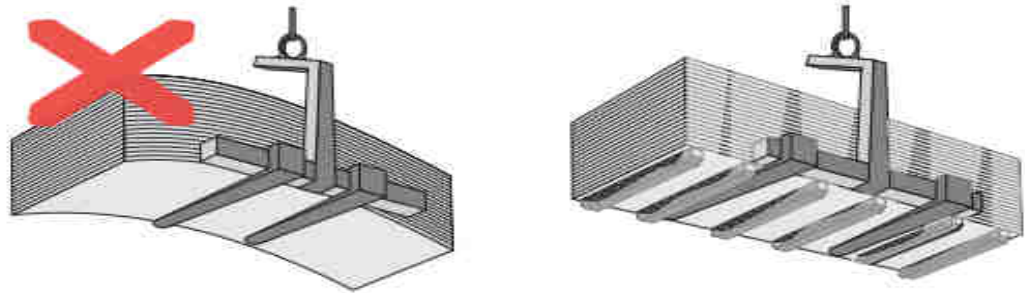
Transporte das placas de drywall (Associação Brasileira do Drywall, 2016)
